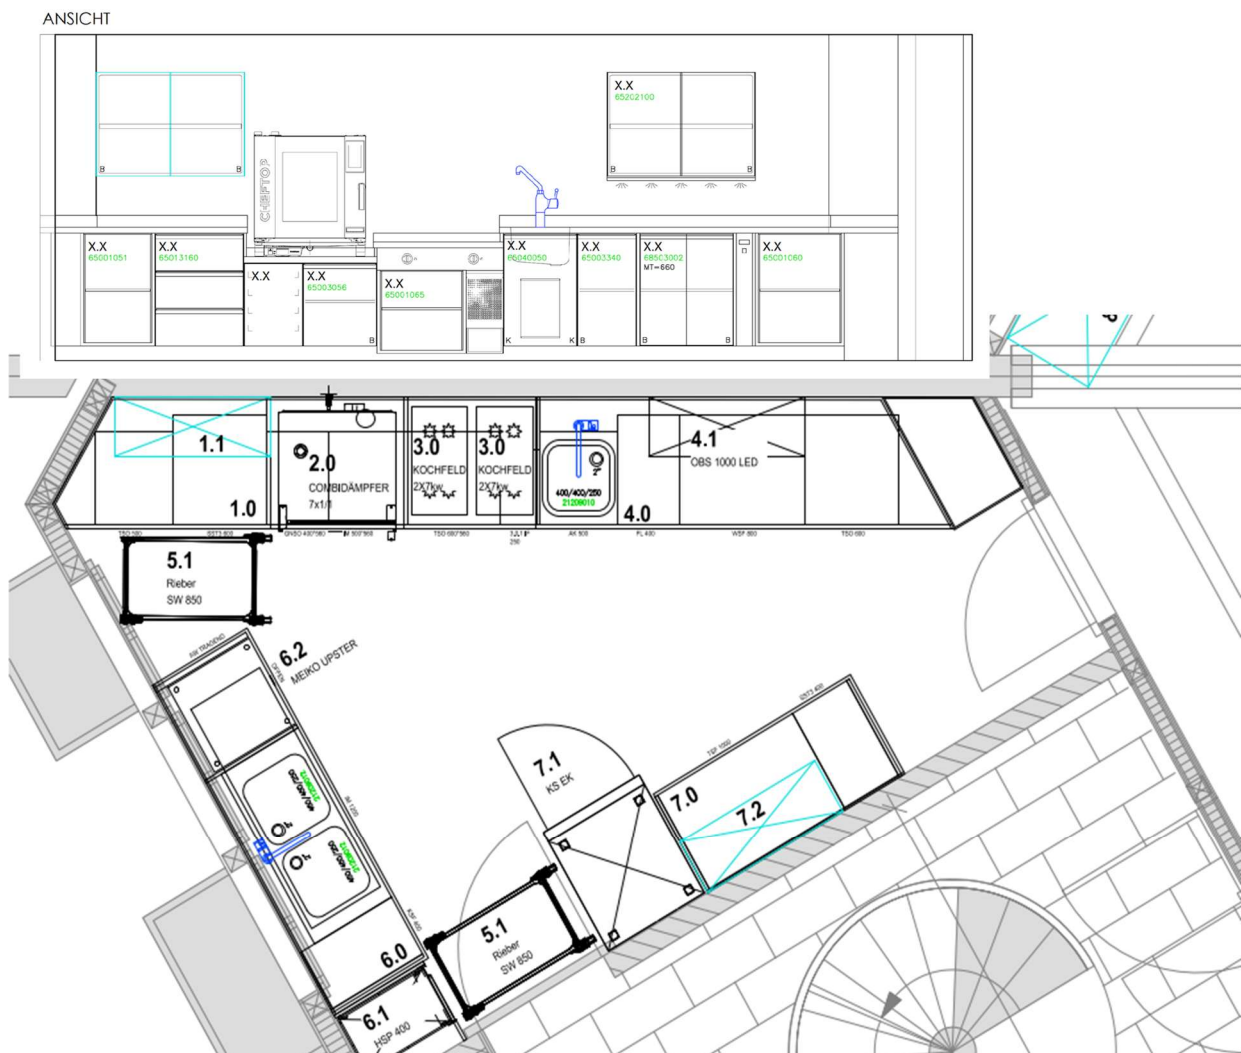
Grundriss Küche und Ansicht Kochlinie
